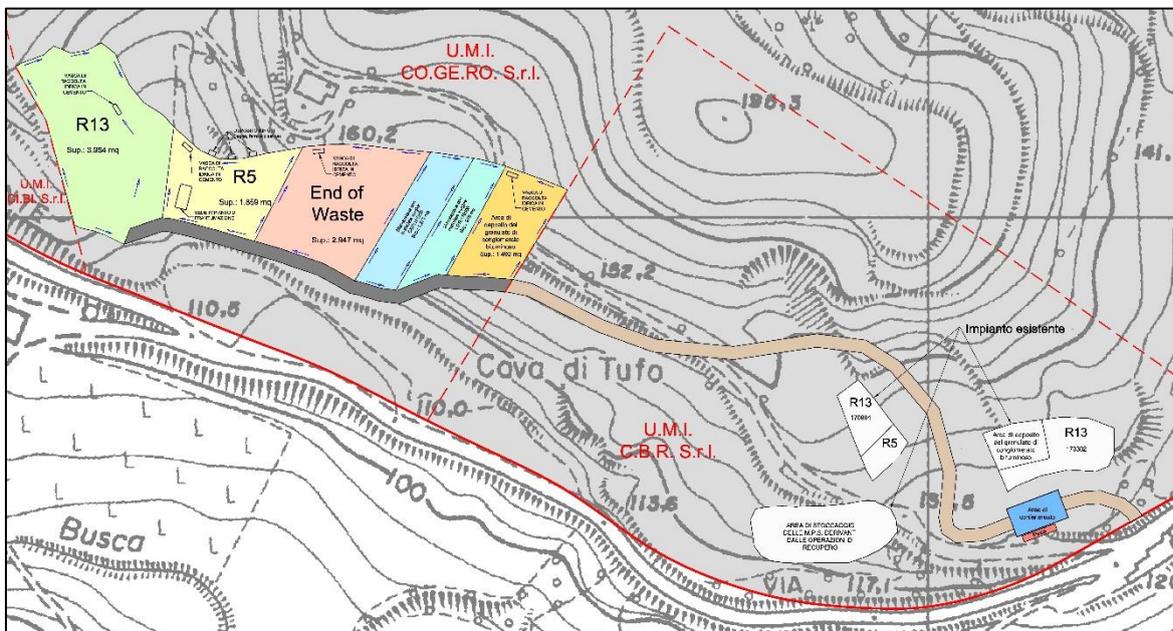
Planimetria dell'impianto per la gestione di rifiuti da costruzione e demolizione in progetto ubicato all'interno dell'U.M.I. CO.GE.RO. S.r.l.
